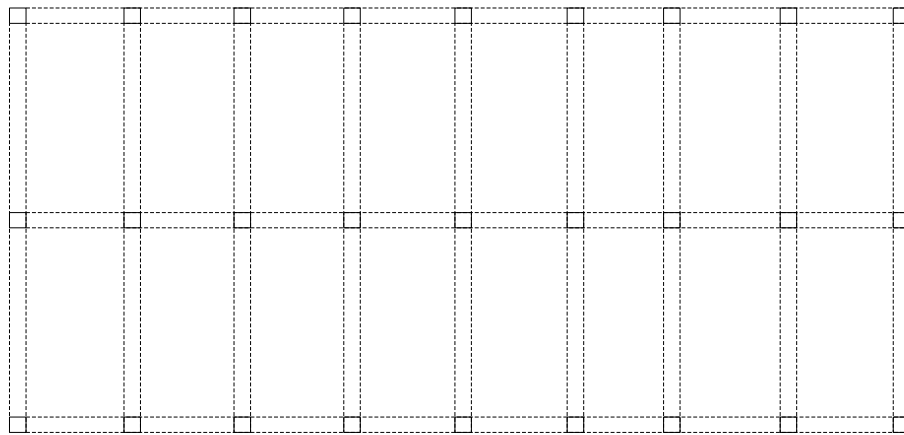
5 Arreglo típico de un pórtico de hormigón
